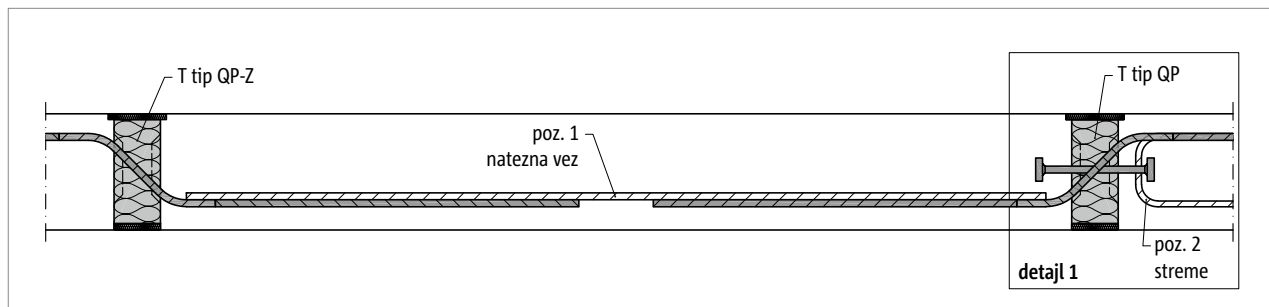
Schöck Isokorb® T tip QP-Z, QP: tloris lože
